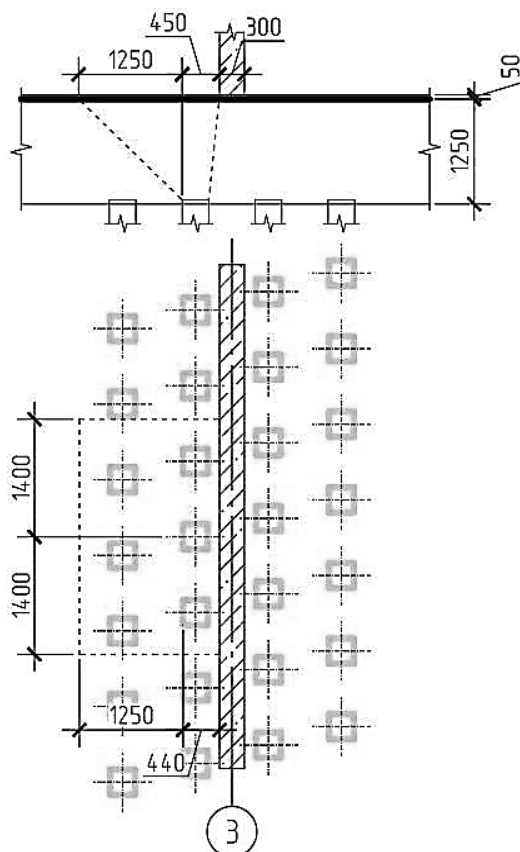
Схема до розрахунку плитного фундаменту на продавлювання
